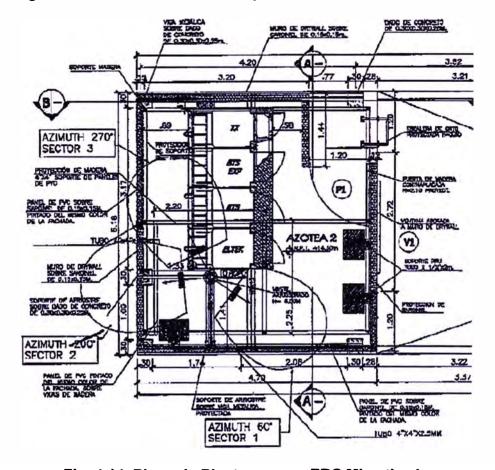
Plano de Planta para un EBC Mimetizada
